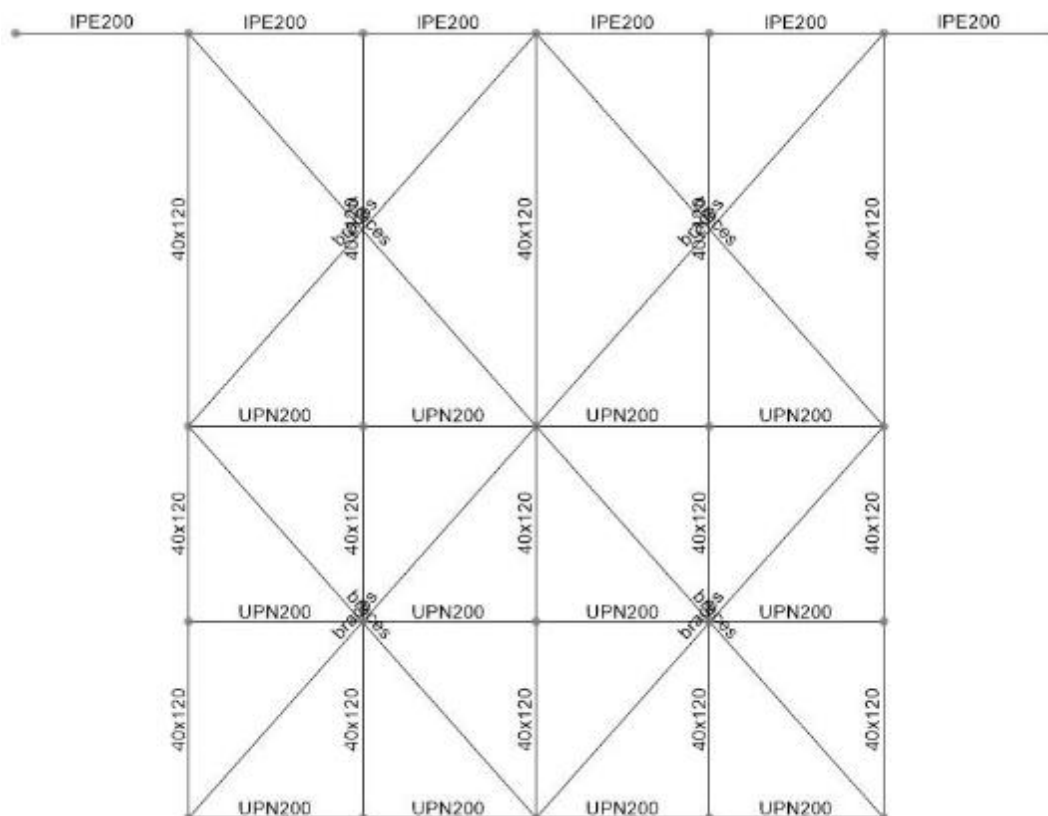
Sezione longitudinale perimetrale (y=0m e y=26.1m)
